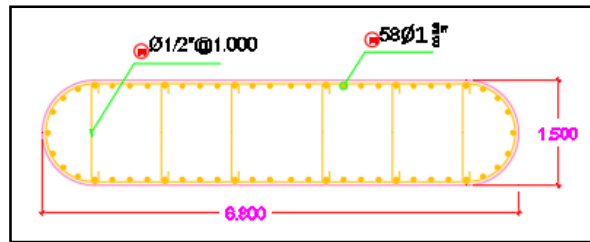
Sección mayor de Pilar N° 1 y N° 2
